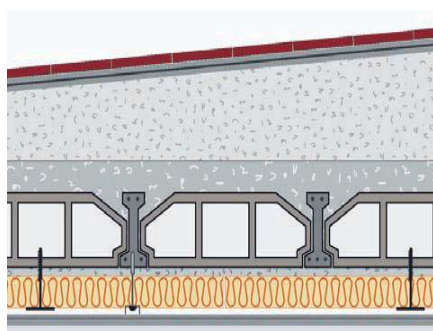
Cubierta plana transitable. Aislamiento por el interior.
